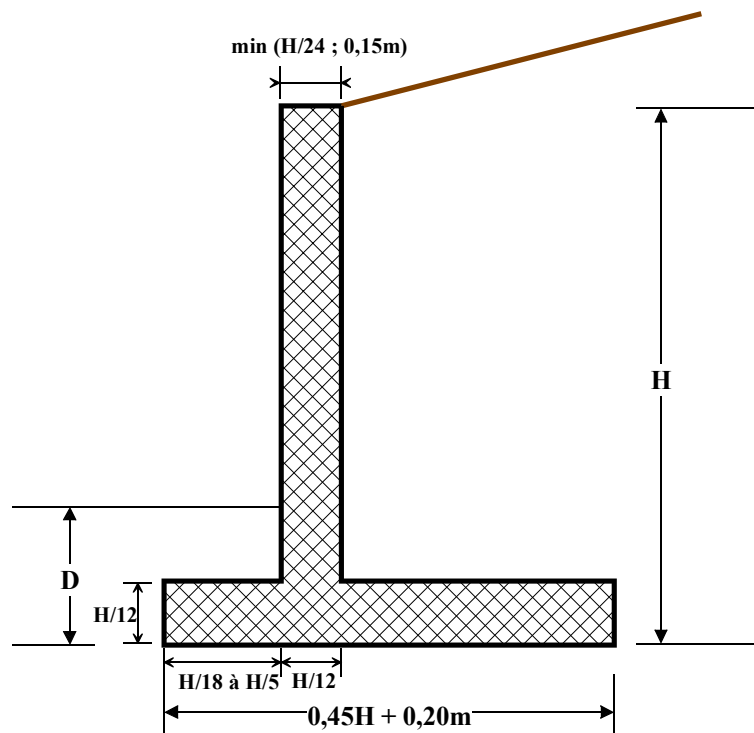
Mur cantilever (B.A., préfabriqué...)
